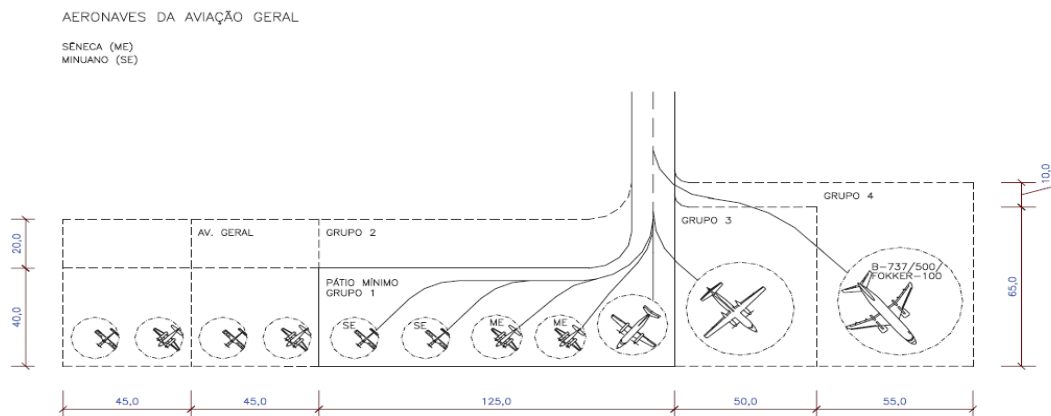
Layout Pista de Táxi - Horizonte Futuro
